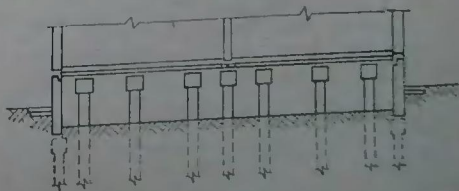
Безростверковый свайный фундамент для крупнопанельных домов
